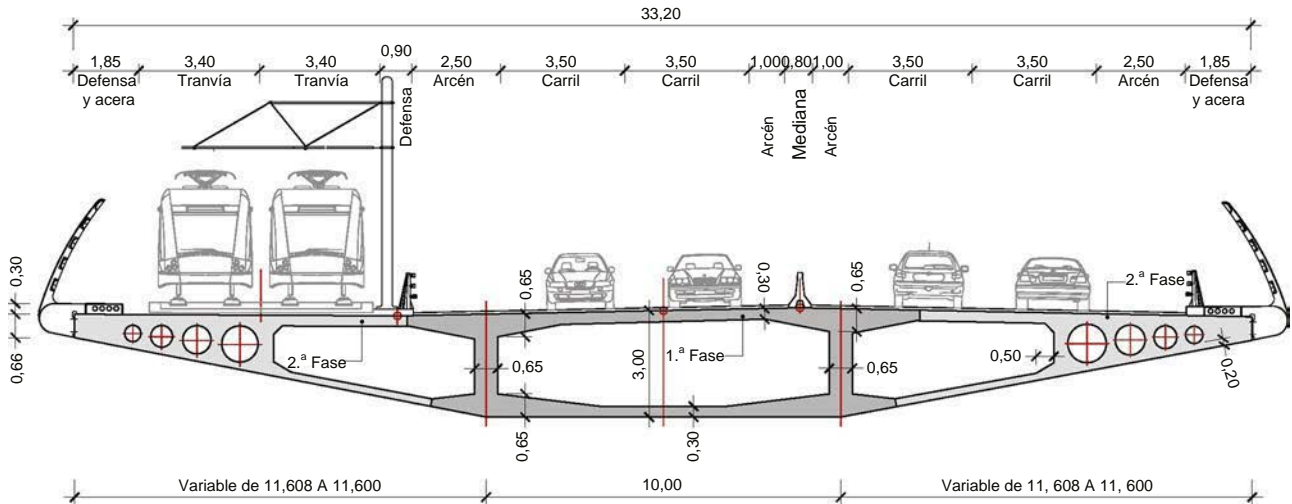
Sección transversal del tramo en cajón tricelular de 3 m de canto.
